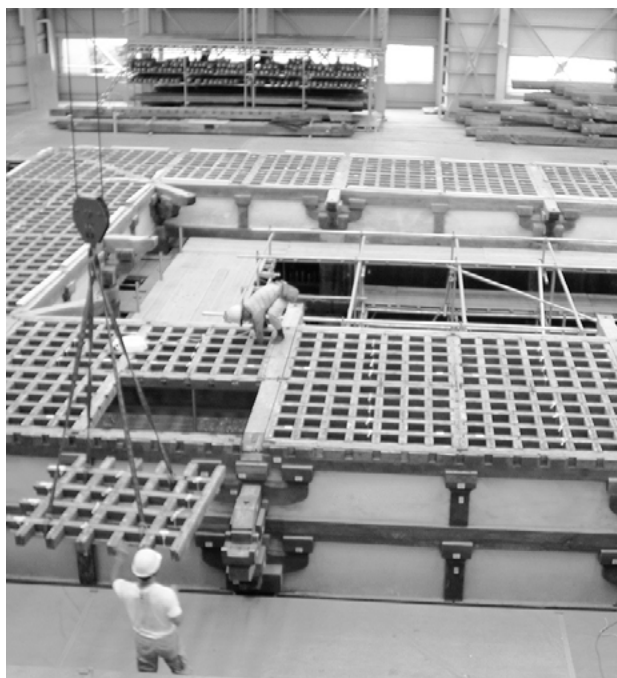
Nara, Tempio buddista Toshodaiji [唐招提寺], Cantiere intervento di restauro Kondō [金堂] (foto B. Galli, 2001).
